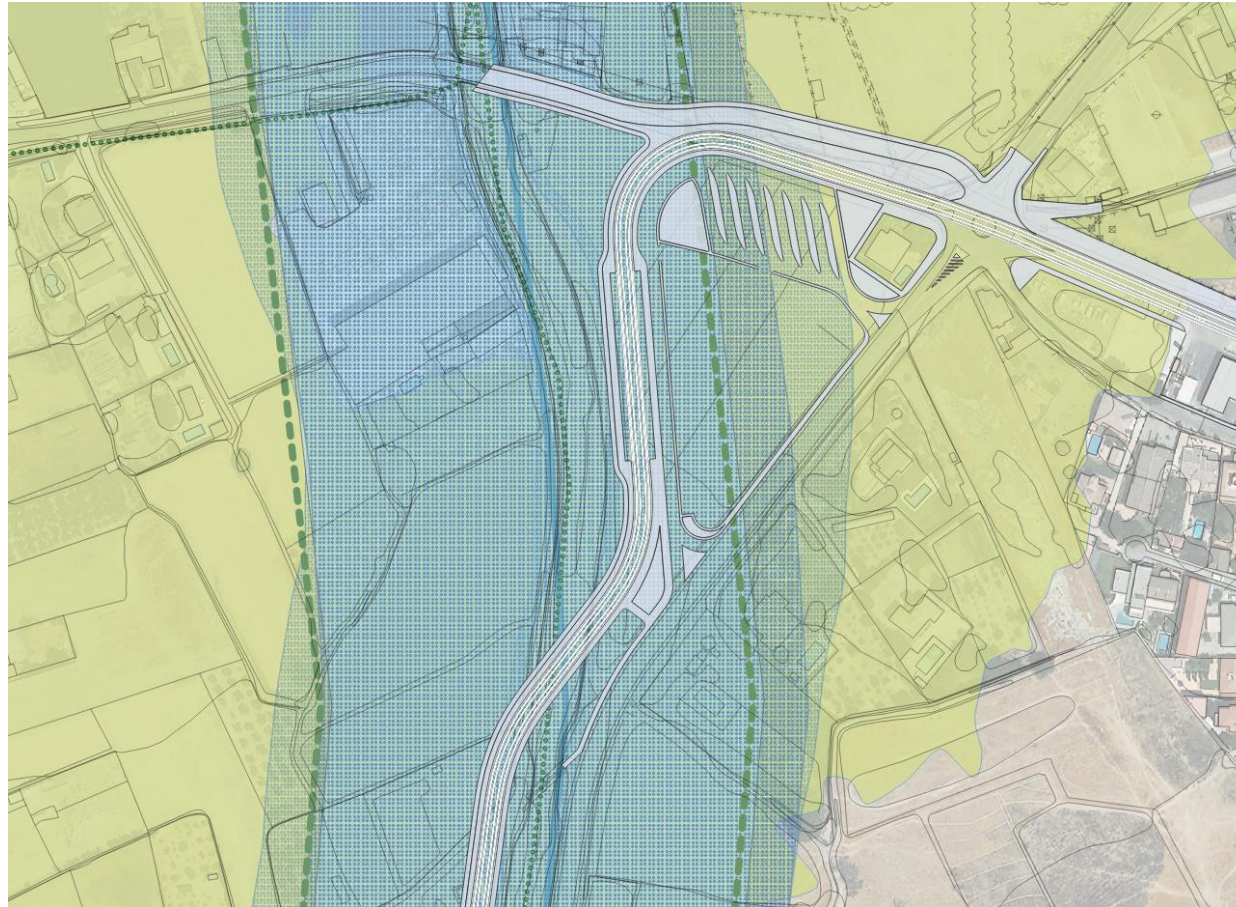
Planimetría aparcamientos disuasorios elaboración propia
